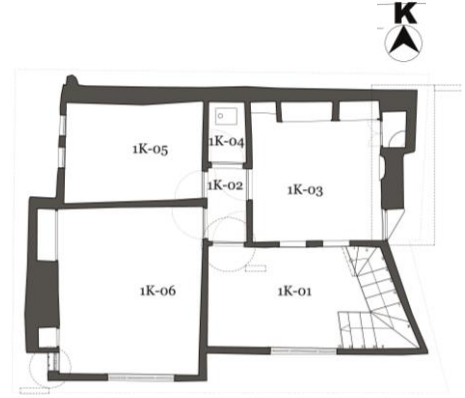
Ateş Konağı Vaziyet Planı [265, 271]
